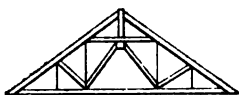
Ferme Palladio en bois pour les pièces comprimées et en fer pour les pièces tendues (tirants); ces pièces sont assemblées à sabots métalliques.
